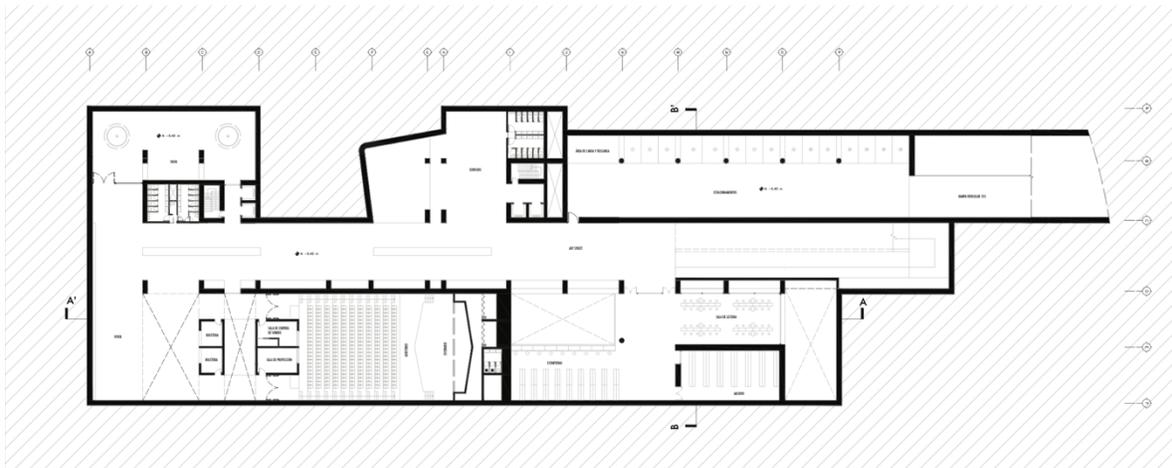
Planta subsuelo 1, N -5.80m. Esc 1:400
